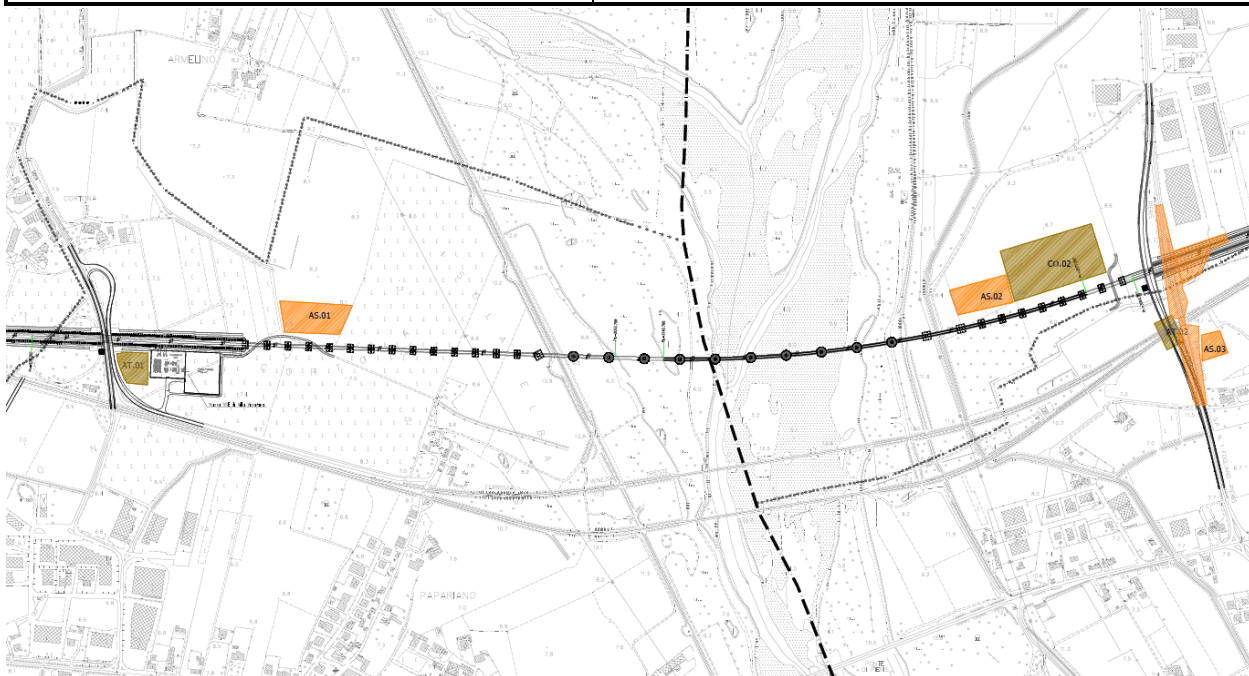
Localizzazione dei cantieri del secondo tratto dell'intervento "Variante Isonzo"
